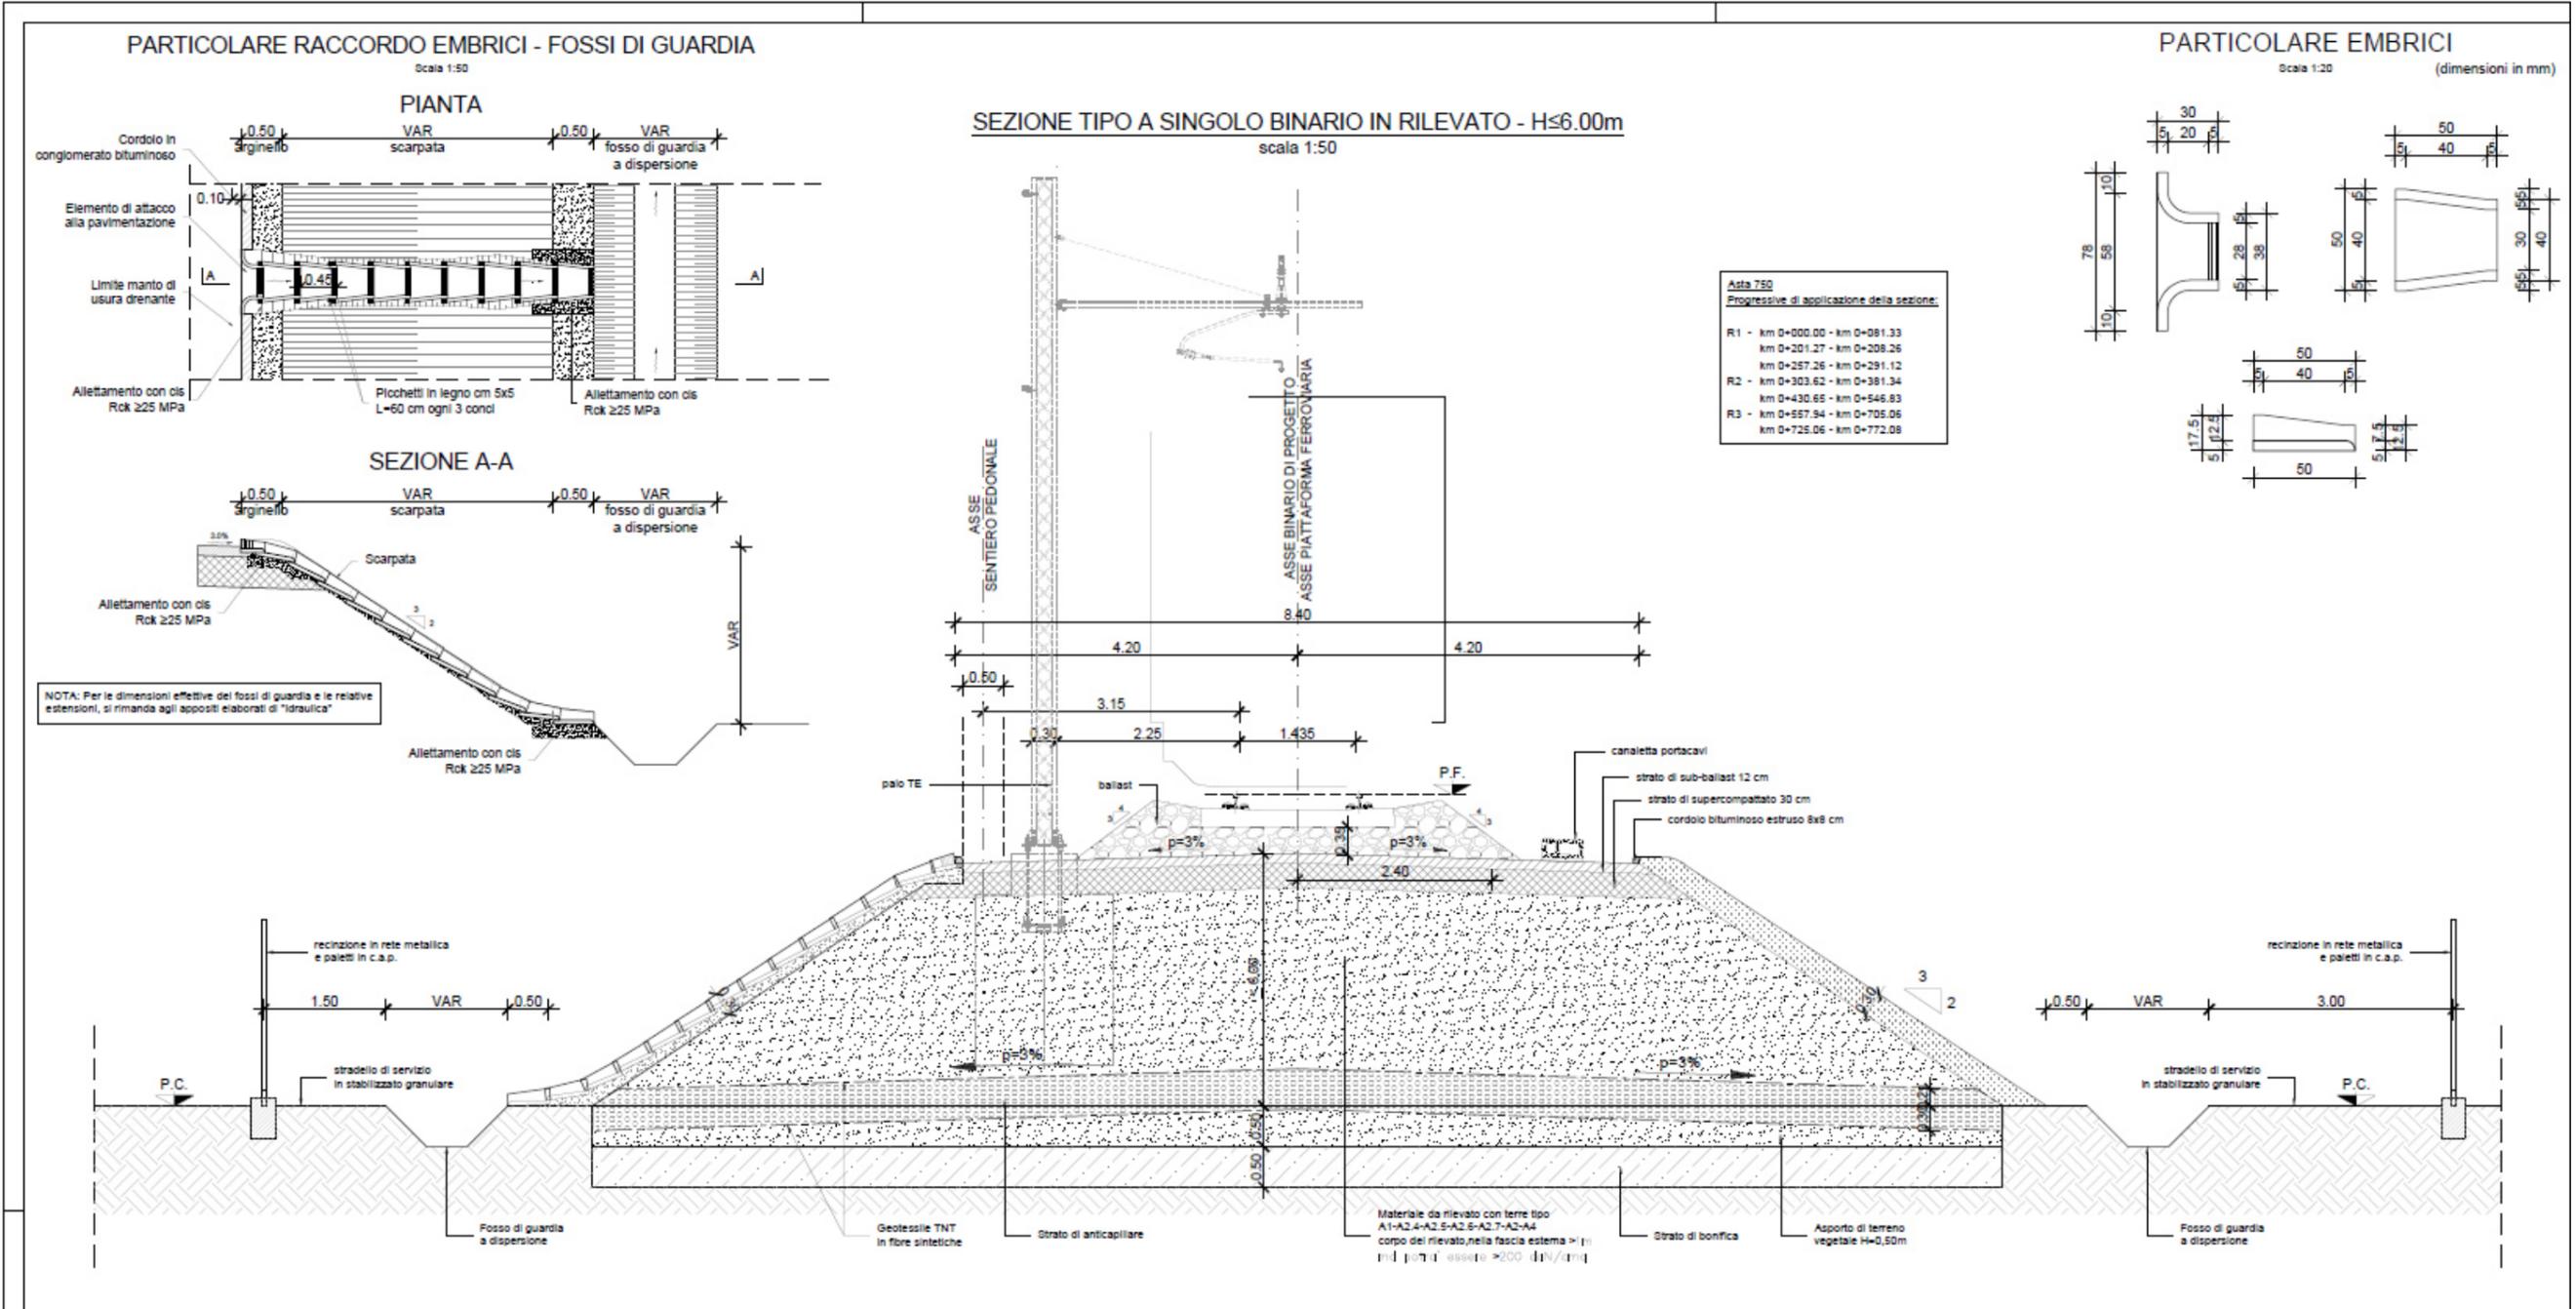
Sezione tipo SB in rilevato - asta L=750m
